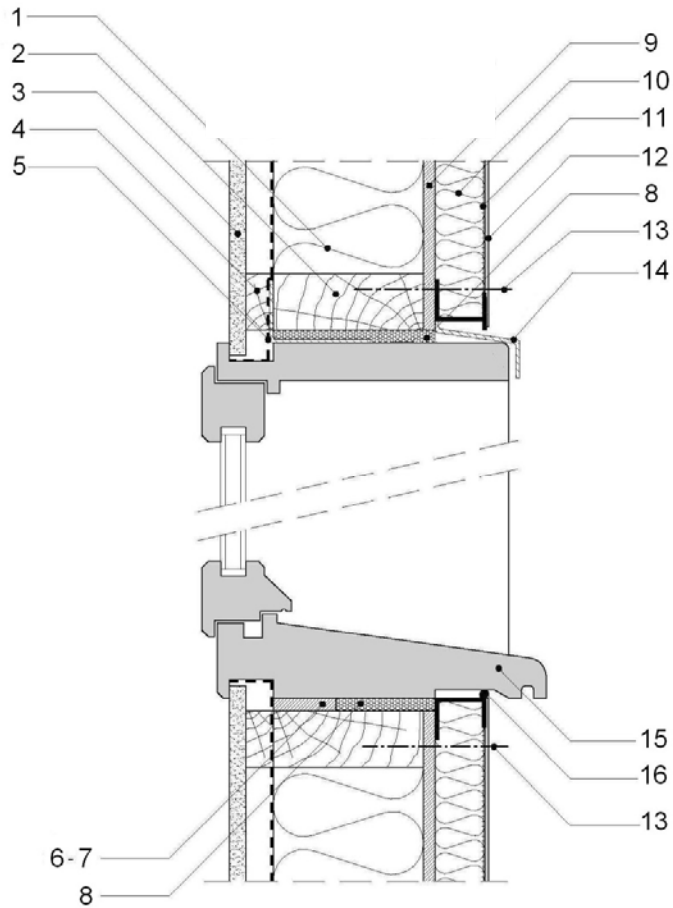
Fixations mécaniques au niveau des baies (coupe verticale)
